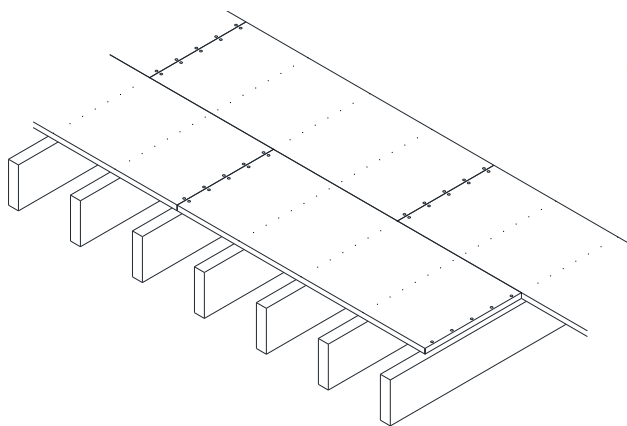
Cerramiento estructural con cantos machihembrados colocado perpendicularmente a las viguetas con el lado menor apoyado sobre las viguetas. UNE ENV 12872
